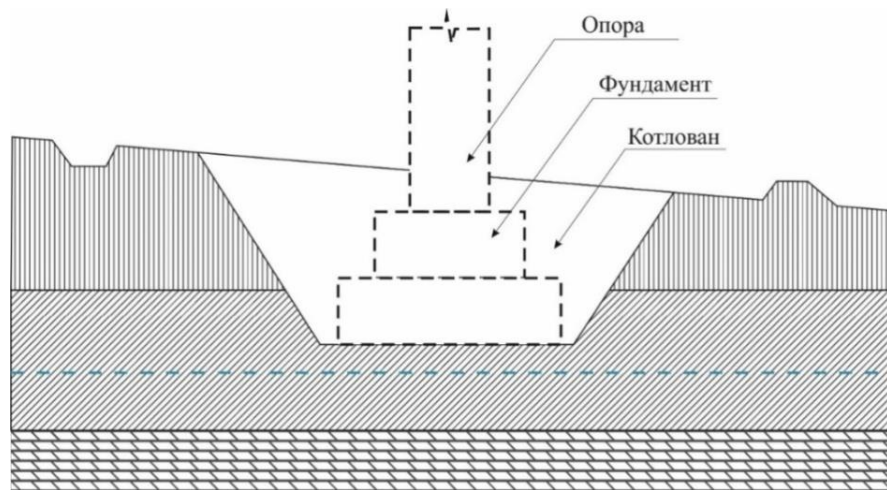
Схема огороження котловану від потрапляння води з поверхні
